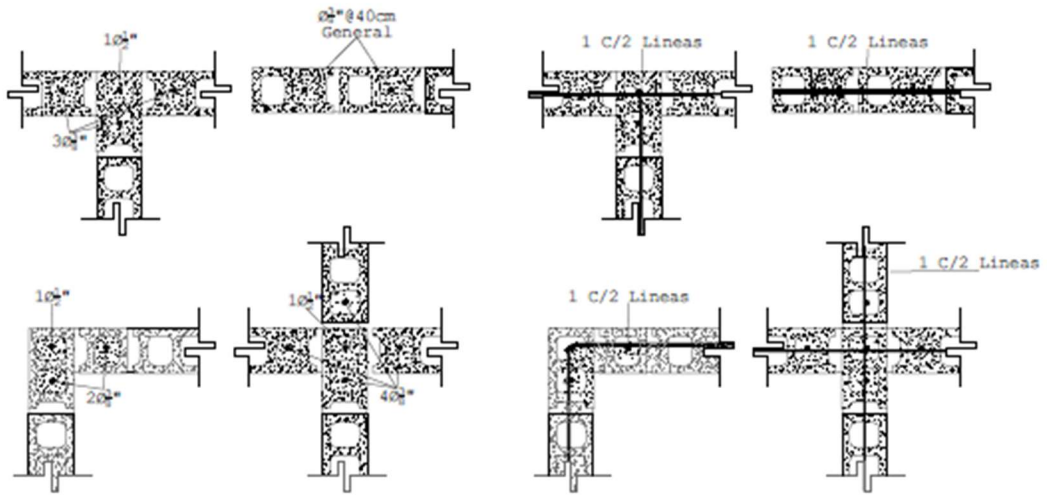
Diseño Estructural para Vivienda en Mampostería – Detalles de Cimientos
